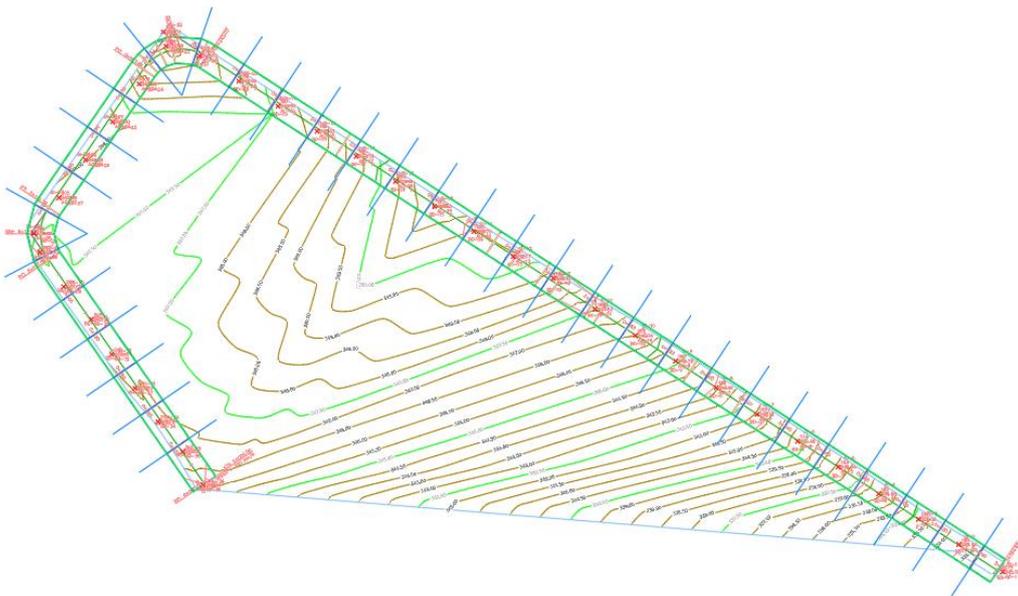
Planimetría y Altimetría de Calle Celestino Sosa. Fuente: Diseño propio.
